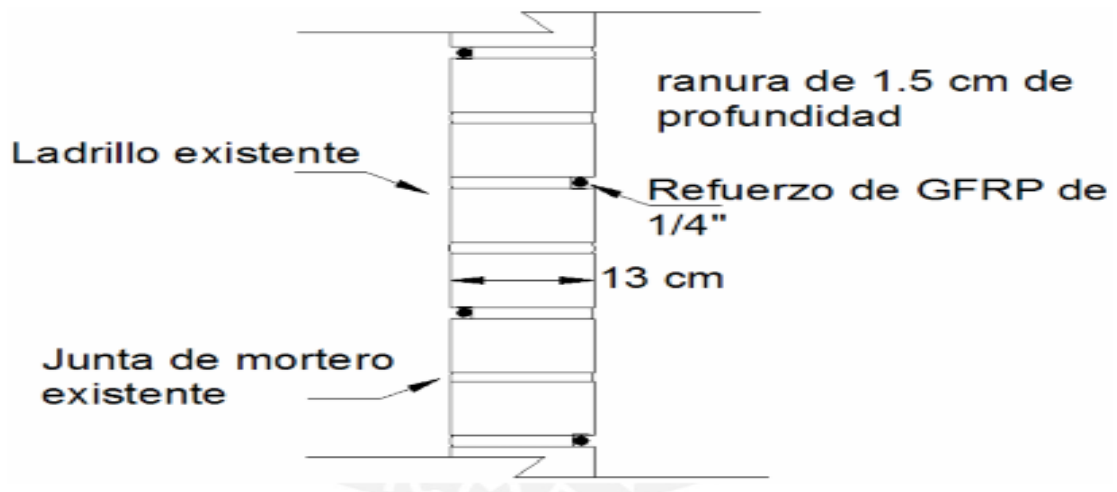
Esquema de colocación de refuerzos de fibra de vidrio GFRP, sección vertical del muro (Fuente: Loayza, 2008)
